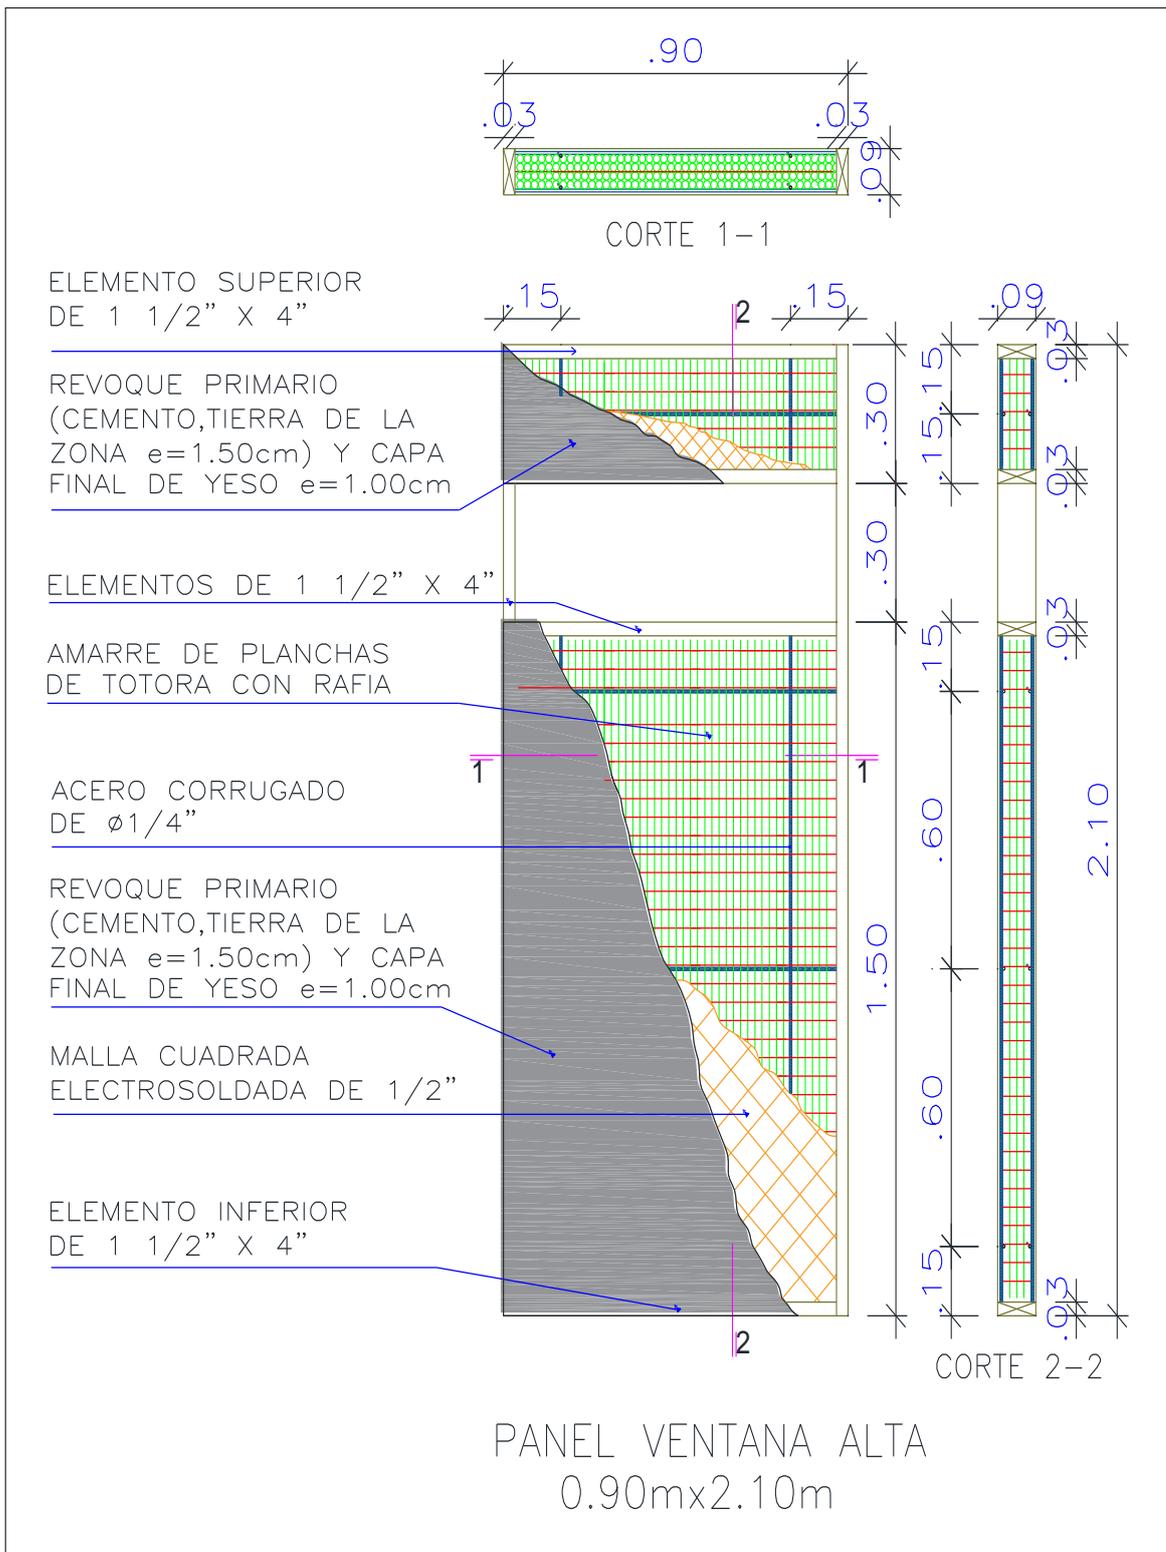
Panel ventana alta 0.90 m x 2.10 m del sistema constructivo propuesto
